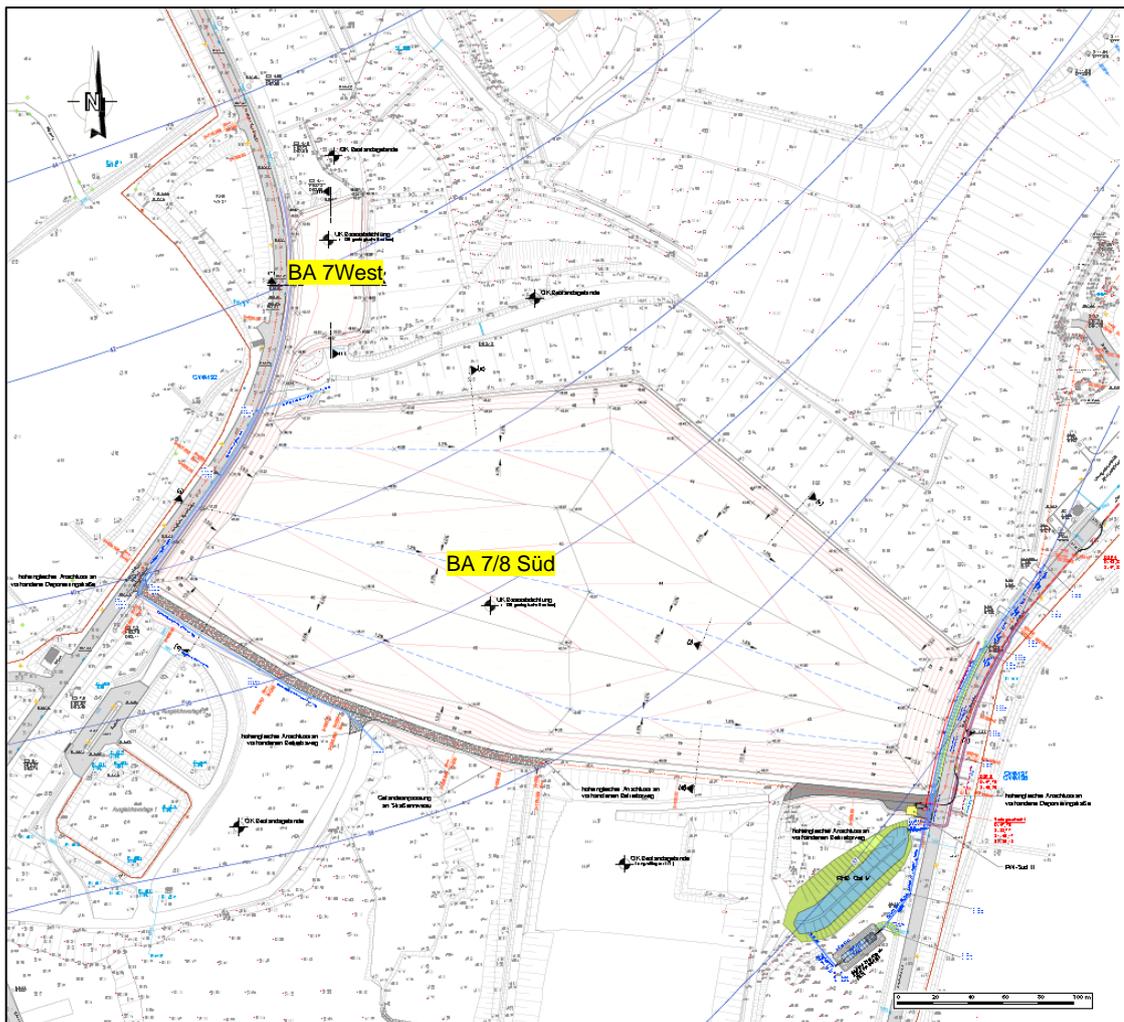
Lageplan (siehe Anhang 2.1 der Antragsunterlage)
